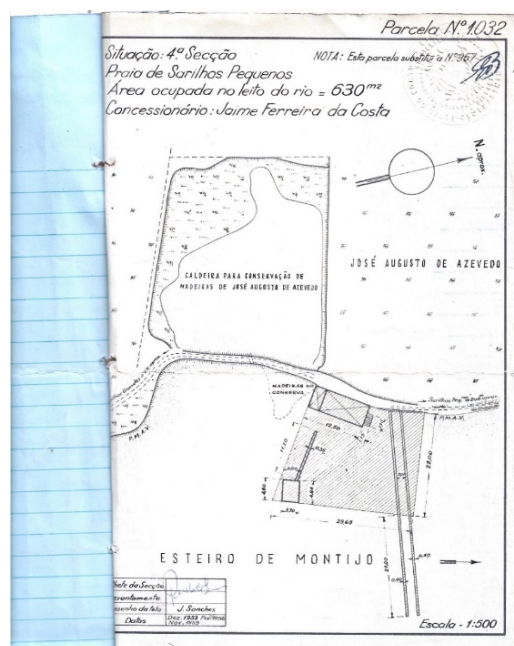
Planta da concessão feita a Jaime Ferreira da Costa em 1960.
